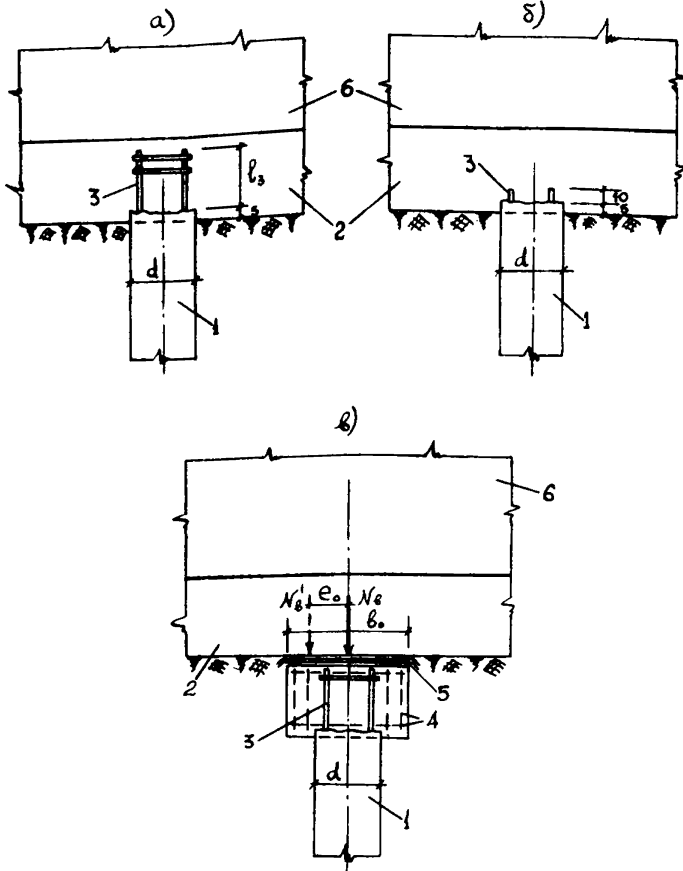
Схемы сопряжения голов свай с ростверком: а) - жесткая заделка; б) - шарнирное сопряжение; в) - сопряжение через шов скольжения; 1 - свая; 2 - ростверк; 3 - выпуски арматуры из свай (l_2 - длина заделки по расчету); 4 - армирование оголовка свай; 5 - шов скольжения; 6 - стена; d - ширина поперечного сечения свай; b_0 - размер оголовка свай; N_0 - положение равнодействующей нагрузки на сваю до подработки; N_0 - то же во время подработки; e_0 - эксцентриситет нагрузки при подработке.
